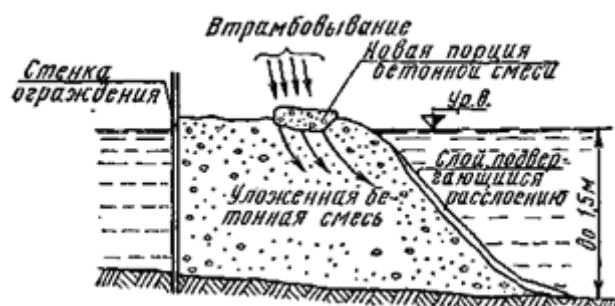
Схема подводного бетонирования методом втрамбовывания бетонной смеси
